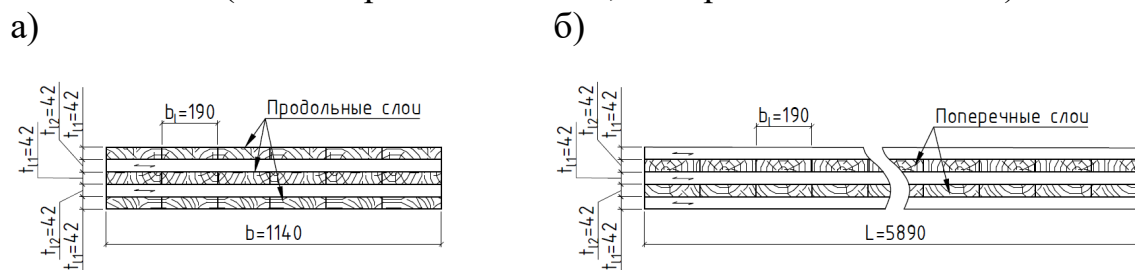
Пятислойная плита перекрытия из ДПК
